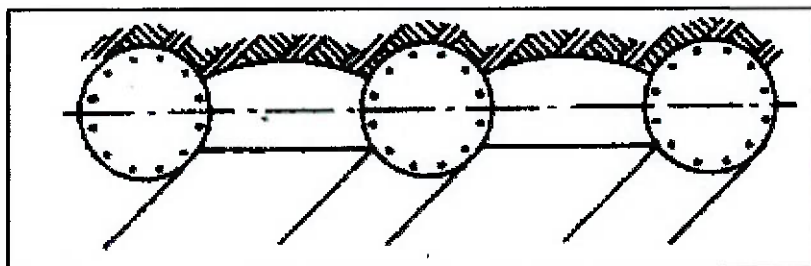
Muros de estacas isoladas com preenchimento de espaço
